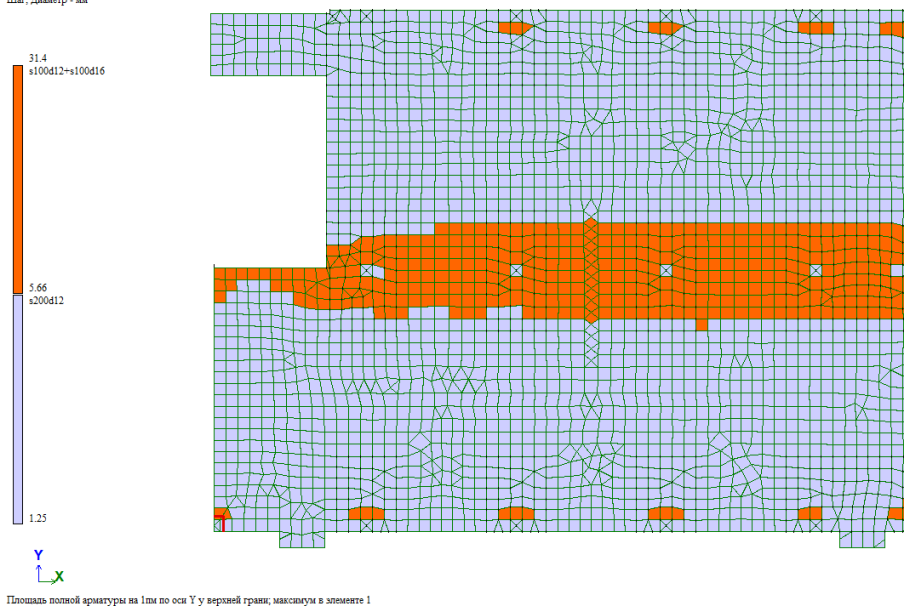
Площадь полной арматуры на 1м по Y у верхней грани
